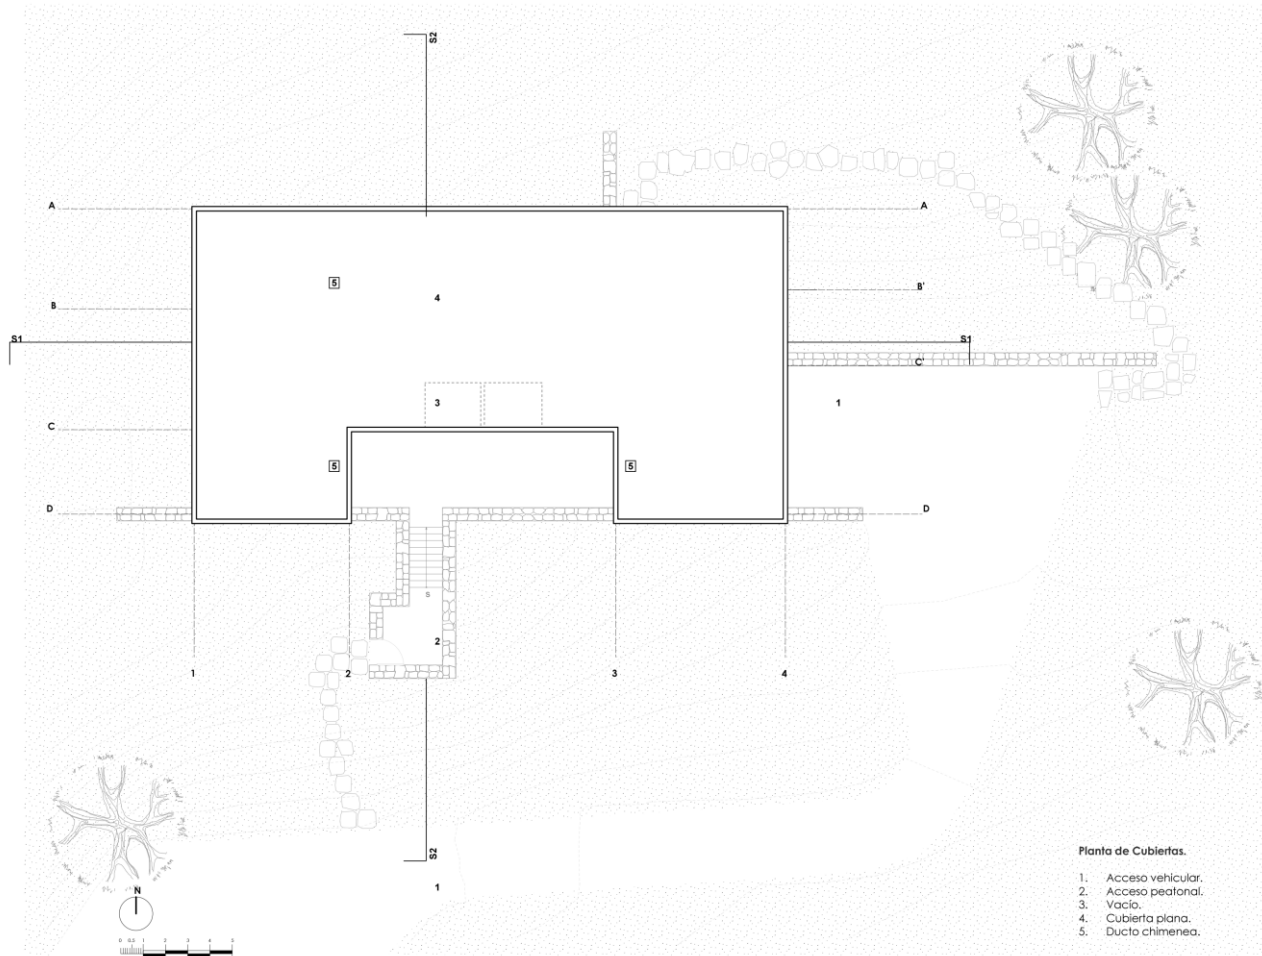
Planta de cubiertas y accesos. Fuente: Autor.
